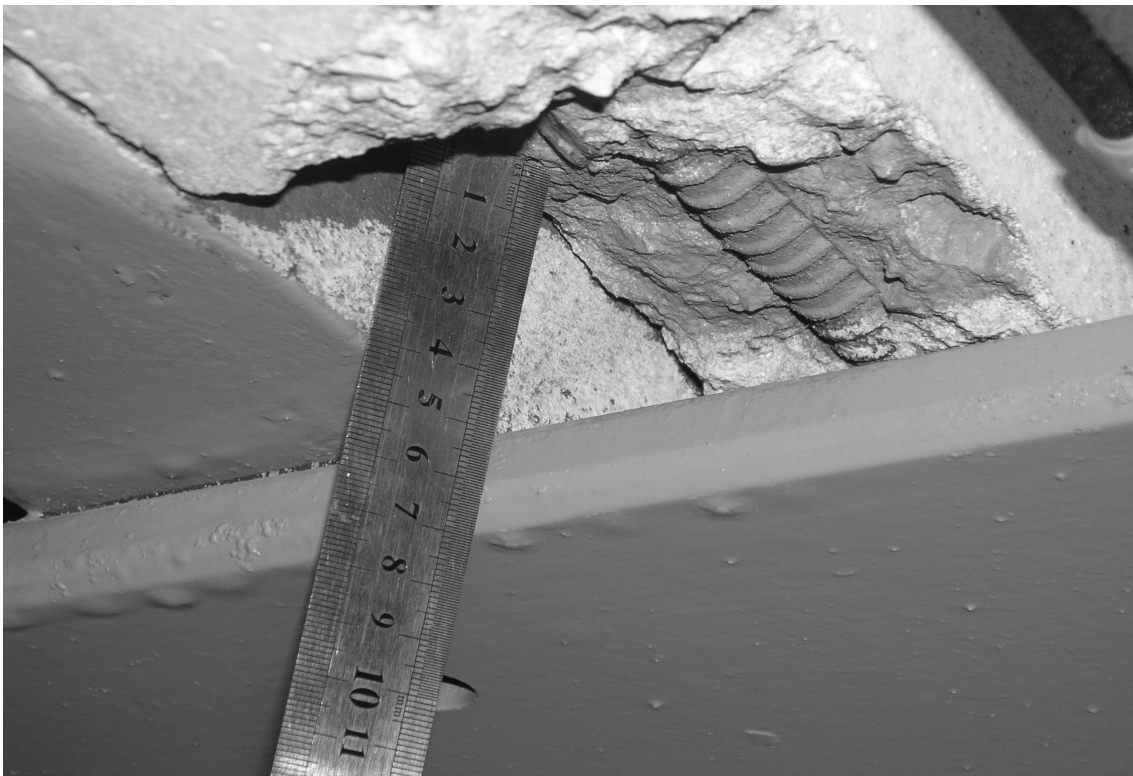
Ж/б плита перекрытия. Разрушение защитного
